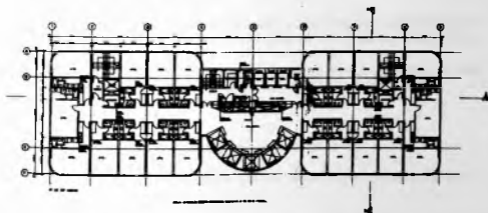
Planta 17º ao 22º andar e 24º andar
